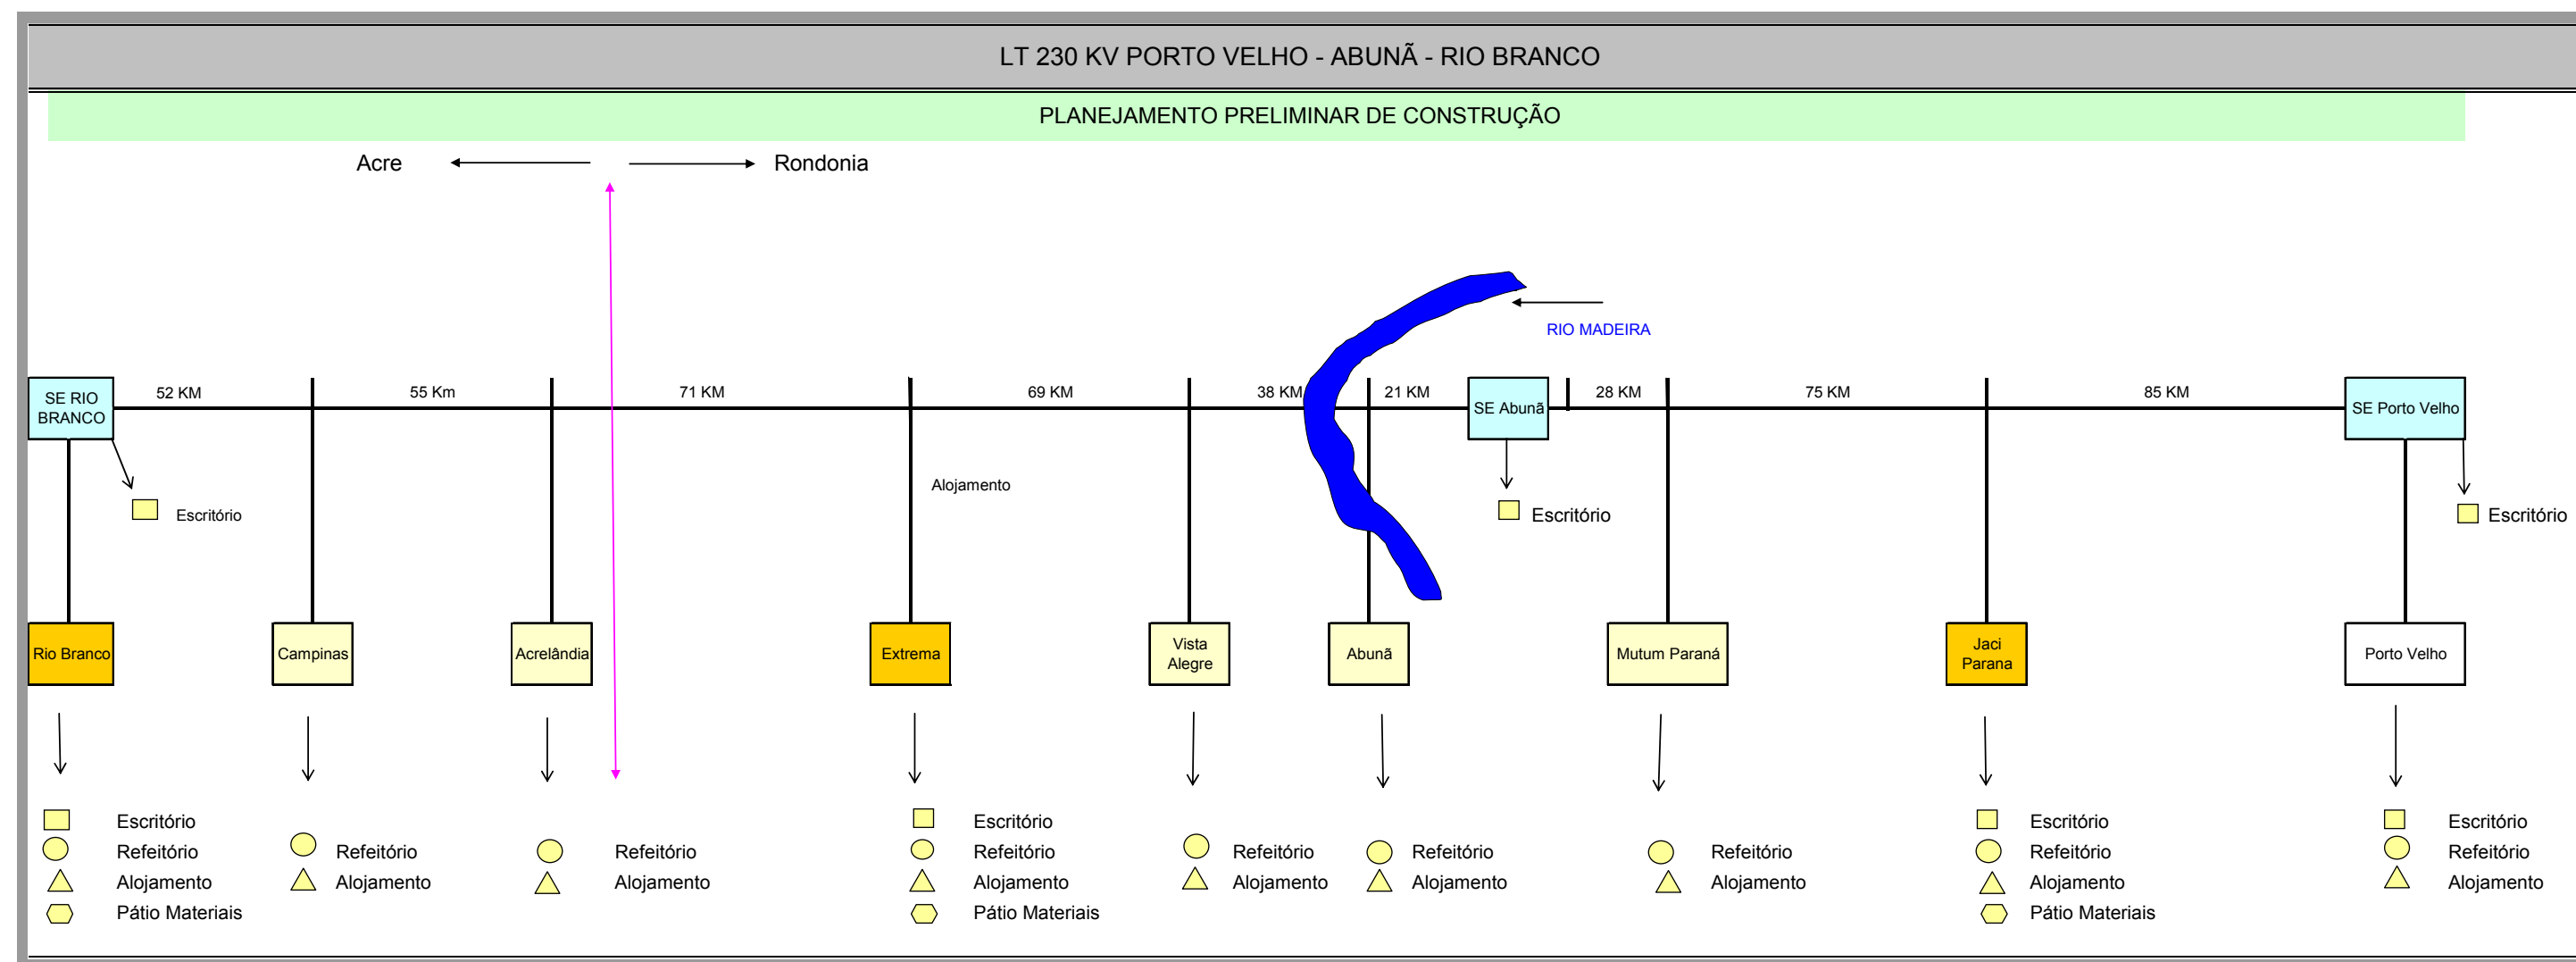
Locais prévios dos canteiros de obras.
